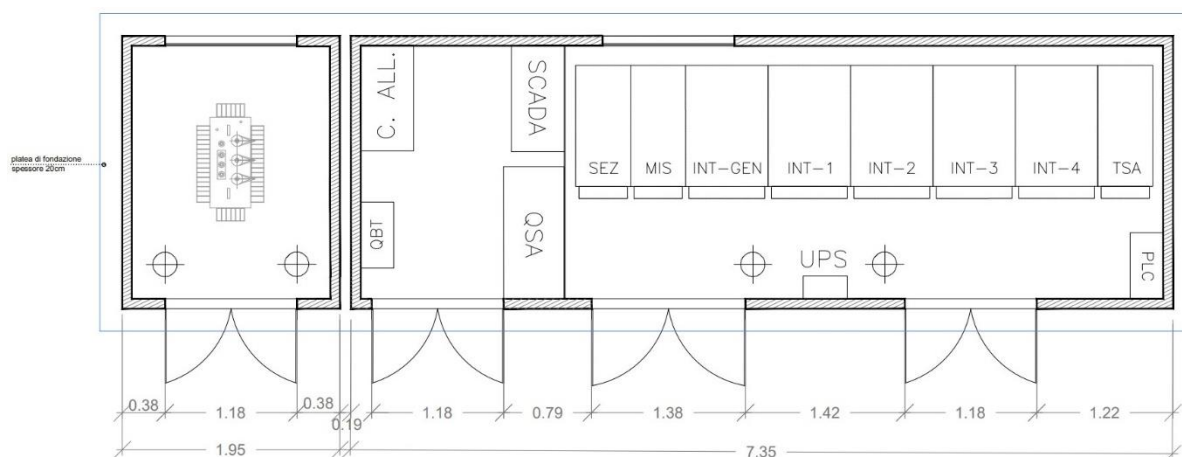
Prospetto struttura di fondazione cabina di sottocampo
